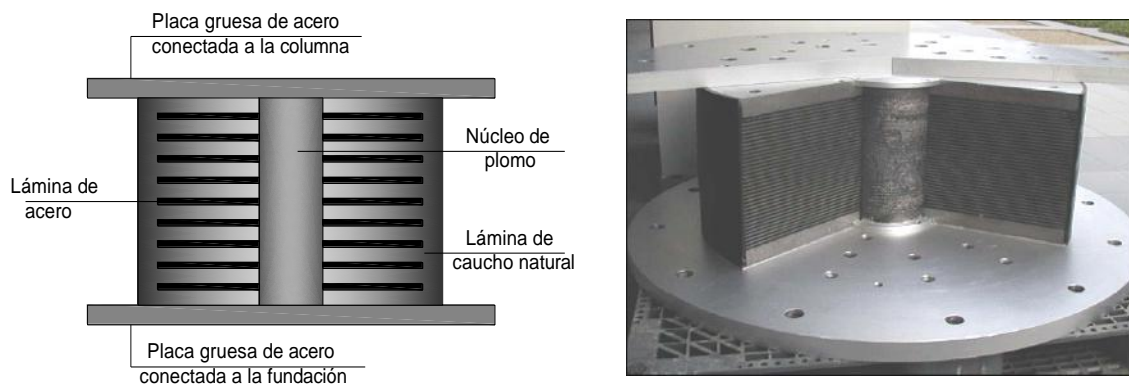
a y b. Componentes del LRB y corte esquemático de un prototipo LRB fabricado por VIBRO-TECH CORPORATION.
